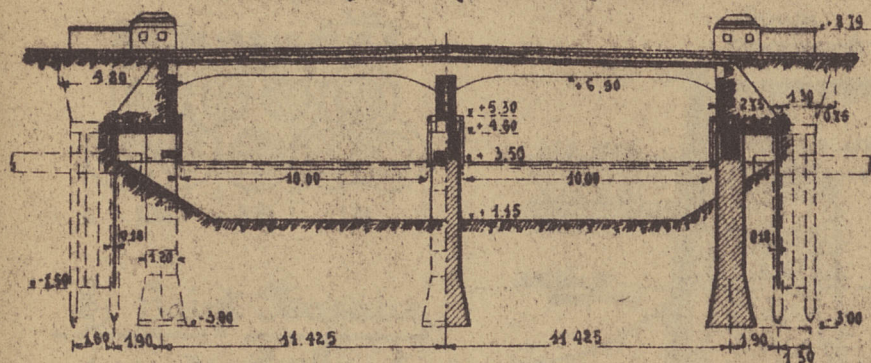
Puits en maçonnerie forcé par havage... Poutre en béton armé. (Métropolitain de Paris, Station, Place des Fêtes.)
